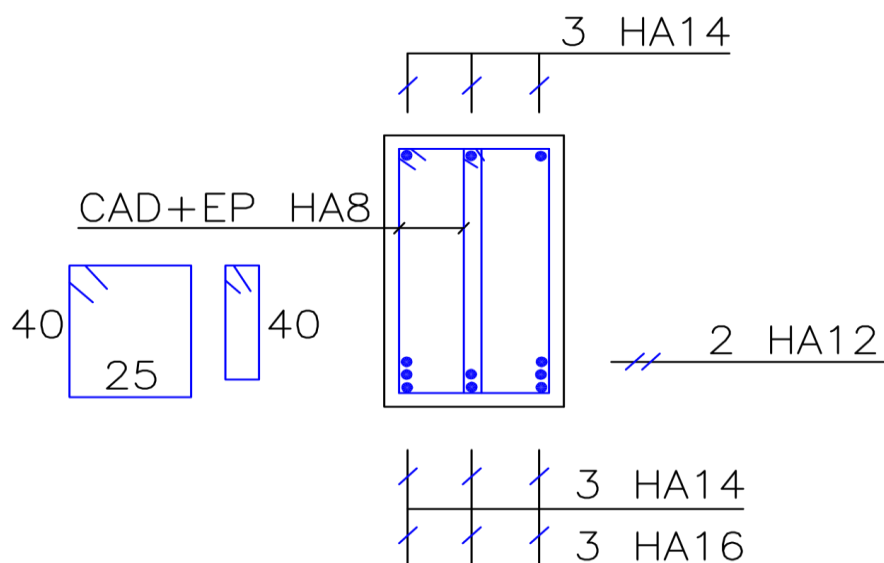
Ferrailage des poutres principales au niveaux terrasse
